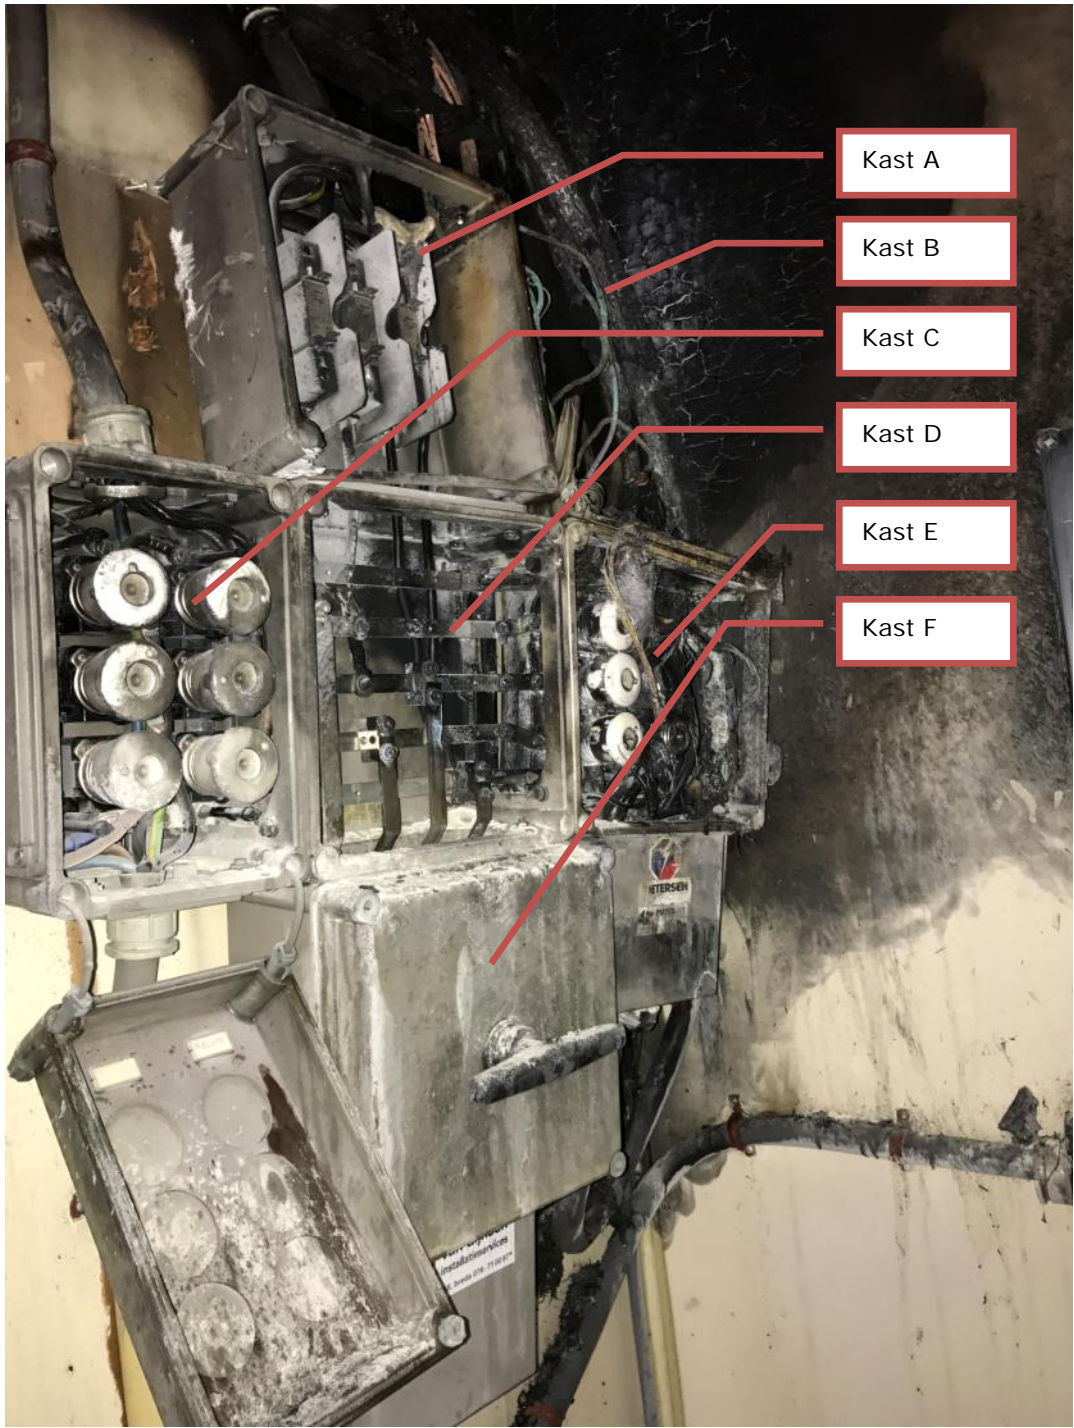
Hoofdverdeelinrichting waarbij slachtoffer aan het werk was ten tijde van het arbeidsongeval. Voor schematische weergave zie bijlage 6.
